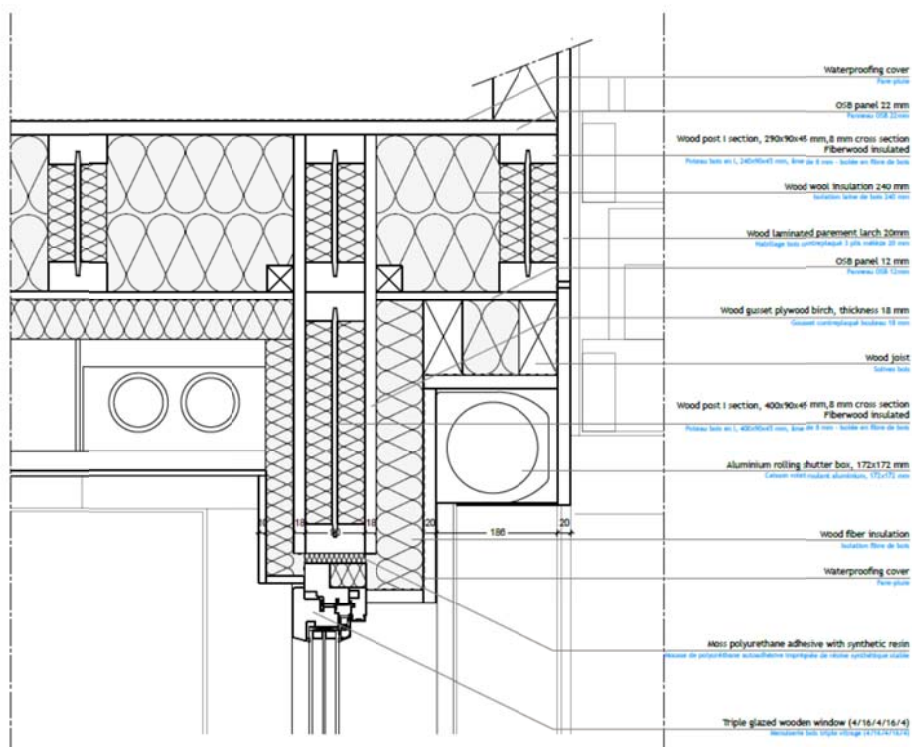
Encuentro cubierta-fachada este-oeste. Fuente: GRE_CD_2010-09-22
